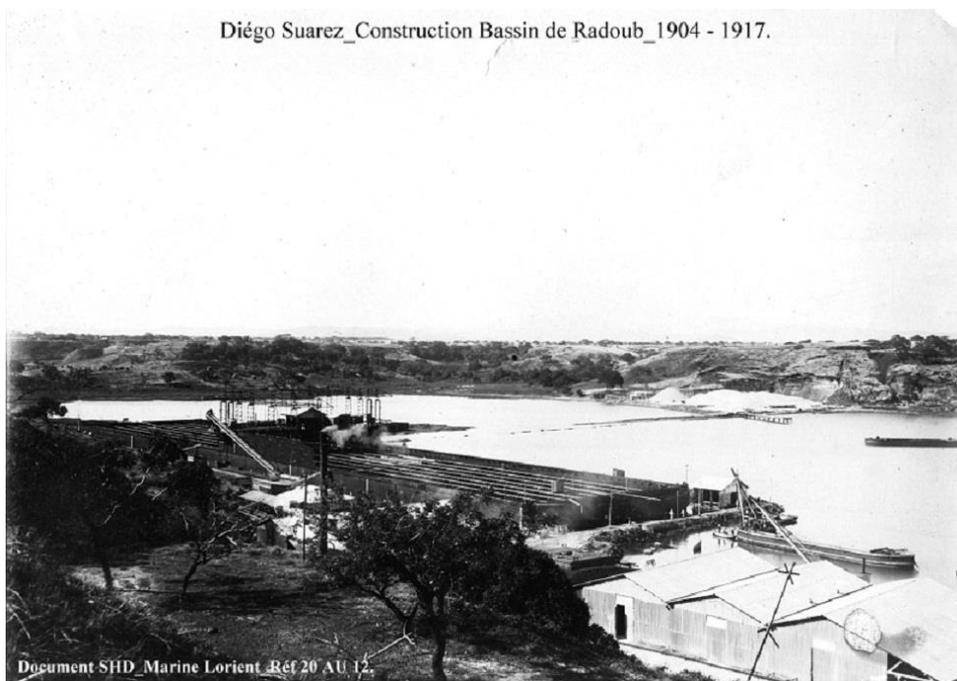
Construction du caisson métallique dans un bassin asséché (Archives SHD)
